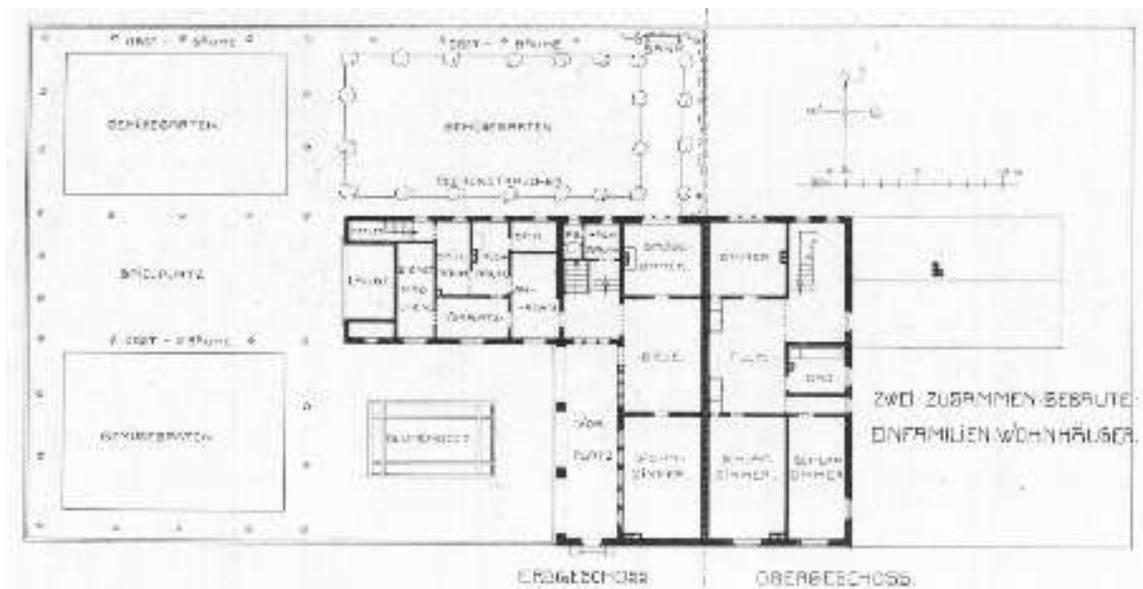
Heinrich Tessenow: Grundriss für zwei zusammengebaute Einfamilien-Wohnhäuser für eine Gartenvorstadt, Pallen bei Trier, Entwurf 1905
